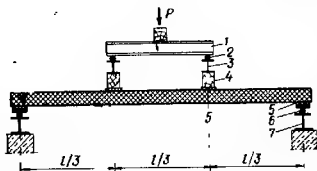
Испытательная установка и передача нагрузки на конструкцию в случае плоских многослойных балок
